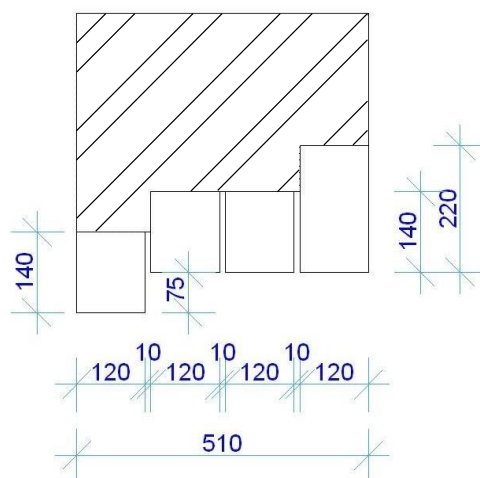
Схема установки перемычек над проемами в наружных несущих кирпичных стенах
